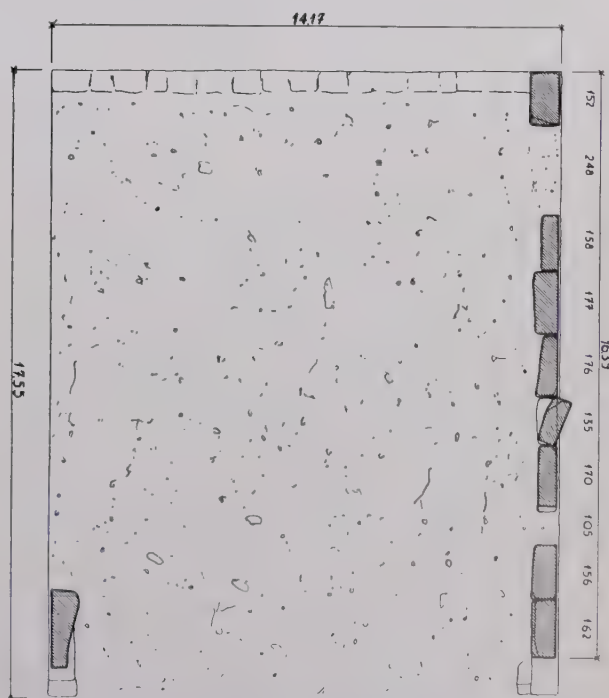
Antico edificio sulla riva del lago di Beyşehir, Pianta
